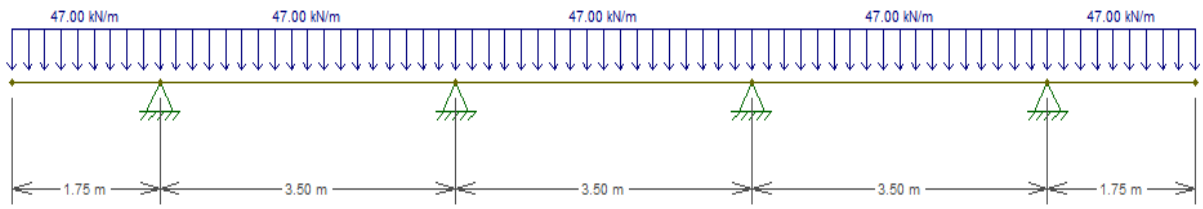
Carregamento na viga horizontal da cortina do talude arenoso.
